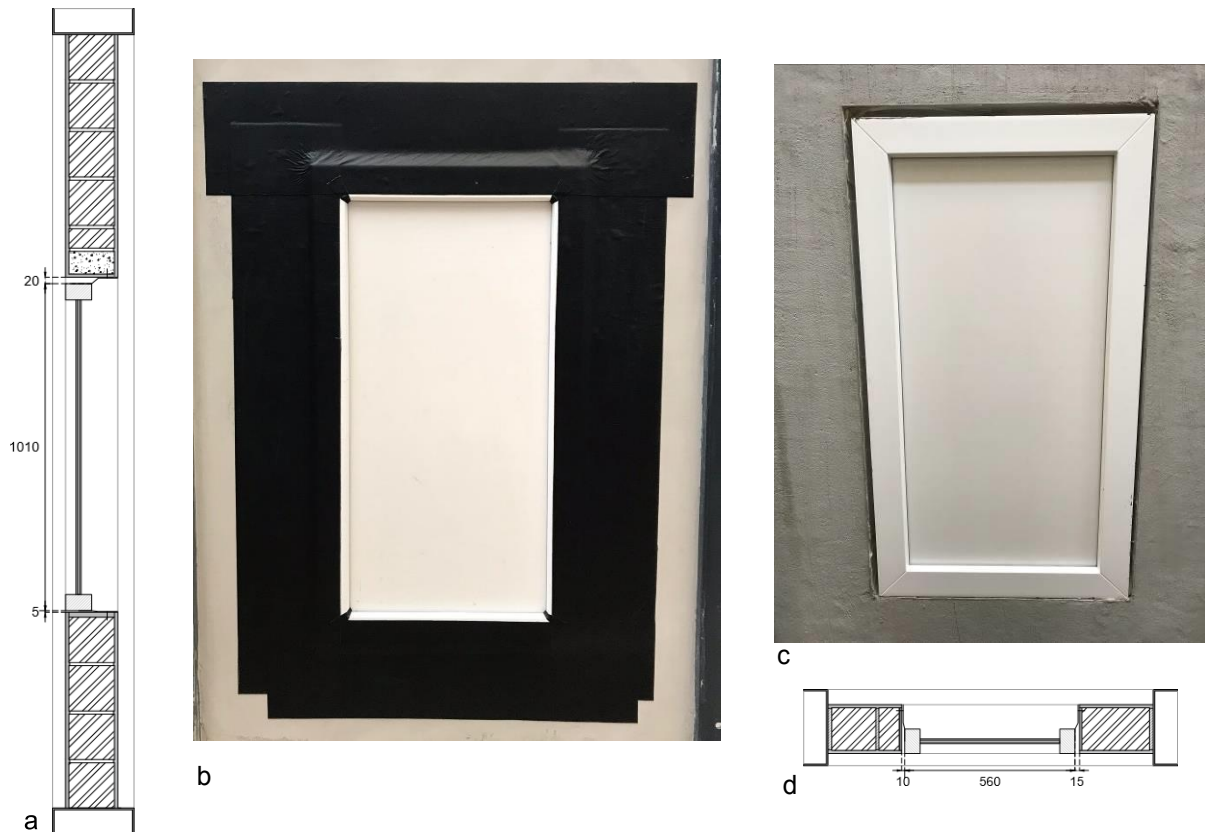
Montage d'essai, a. section transversale, b. face extérieure du mur, c. face intérieure du mur, d. section horizontale
